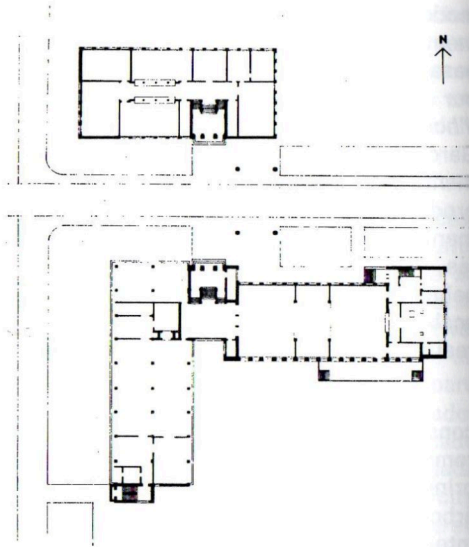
Plano de la planta baja de la Bauhaus, Dessau.
